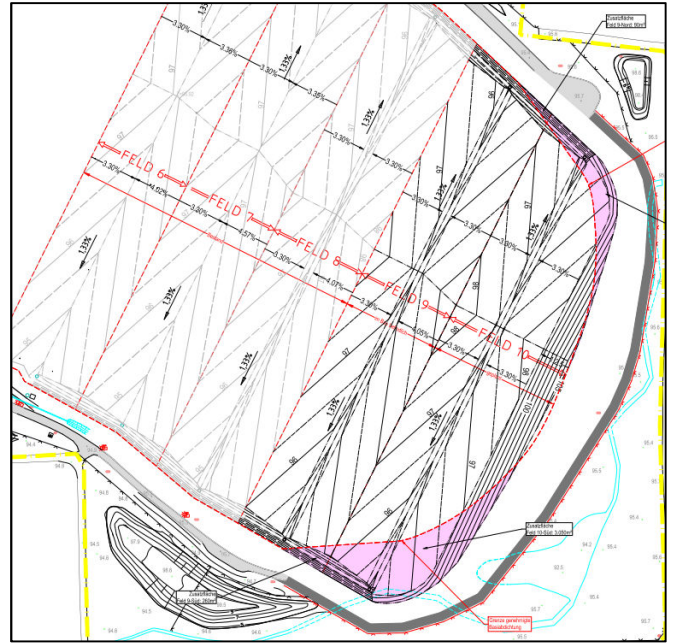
Optimierter Grundriss Basisabdichtung Felder 9+10 und Umbau Deponieumfahrung (Auszug aus Anlage 1.2)
